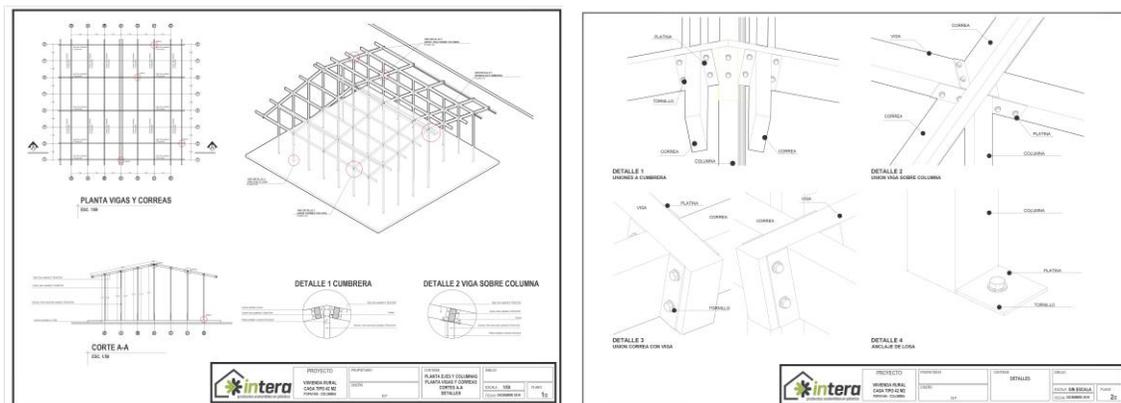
Detalles Constructivos Estructura Metálica. Fuente: Elaboración propia.
